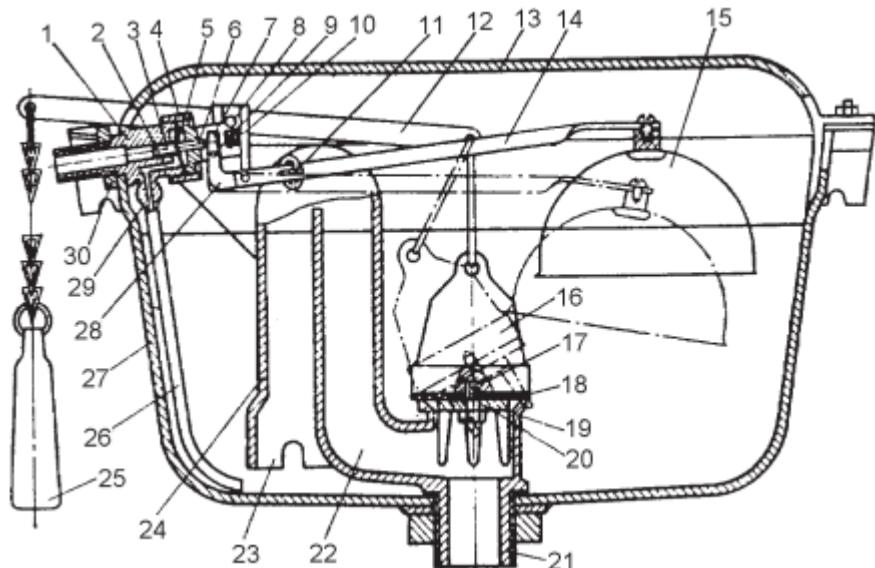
Смывной бачок «Экономия»: 1 – корпус поплавкового клапана; 2 – кольцевая камера; 3 – канал; 4 – накидная гайка; 5 – диафрагма резиновая; 6 – золотник; 7 – верхний конец рычага; 8 – ось рычага; 9 – ось вращения рычага; 10 – винт; 11 – винт рычага; 12 – рычаг спускного клапана; 13 – крышка корпуса; 14 – рычаг поплавка; 15 – винилпластовый поплавок; 16 – спускной клапан; 17 – шайба со штырями; 18 – резиновая прокладка; 19 – кольцевая кромка; 20 – направляющие ребра; 21 – штуцер для присоединения смывной трубы; 22 – воздушная камера сифона; 23 – приемная камера сифона; 24 – сифон; 25 – ручка; 26 – наливная трубка; 27 – чугунный корпус; 28 – рычаг поплавкового клапана; 29 – канал; 30 – прижимная гайка
